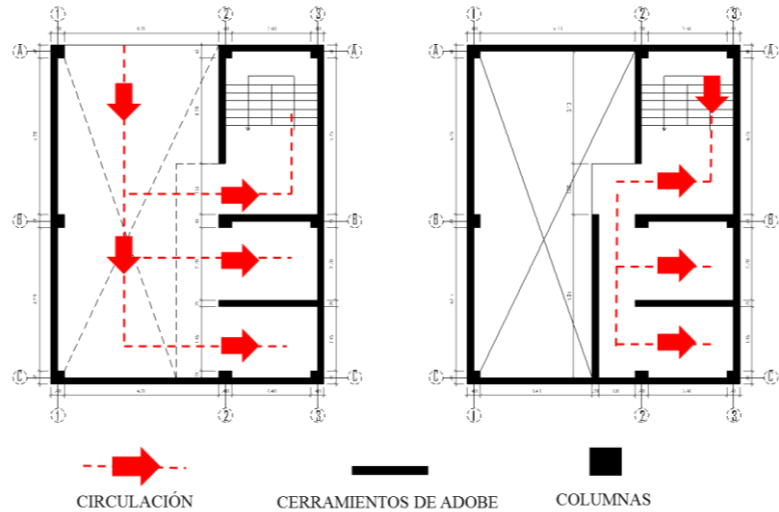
Planta típica de distribución - Tipologías 3. Fuente: propia.
